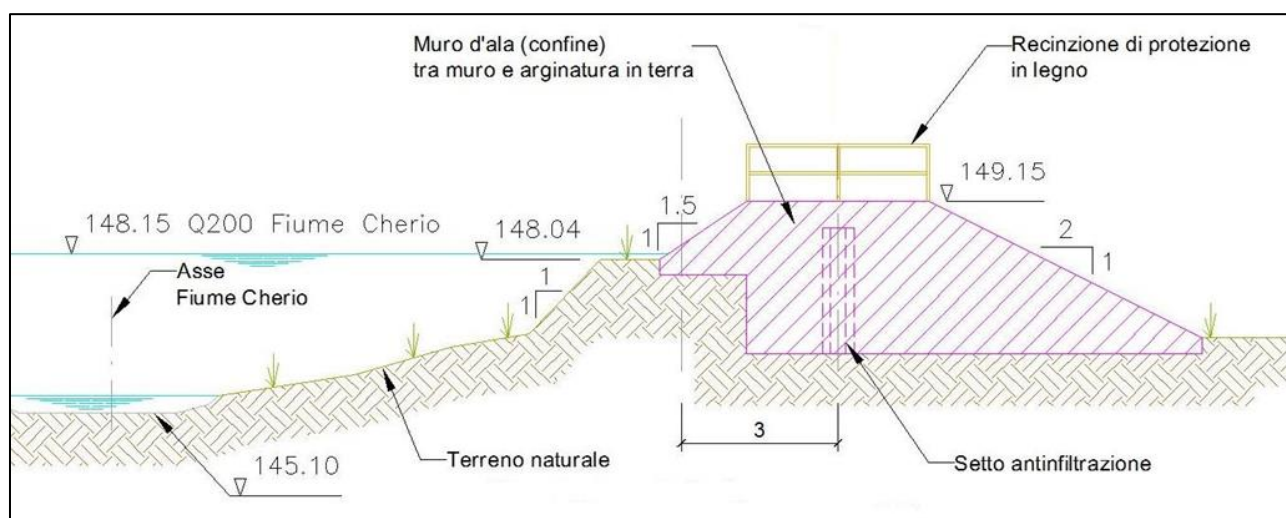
Sezioni tipo muro d'ala muro in c.a. (sponda destra)
